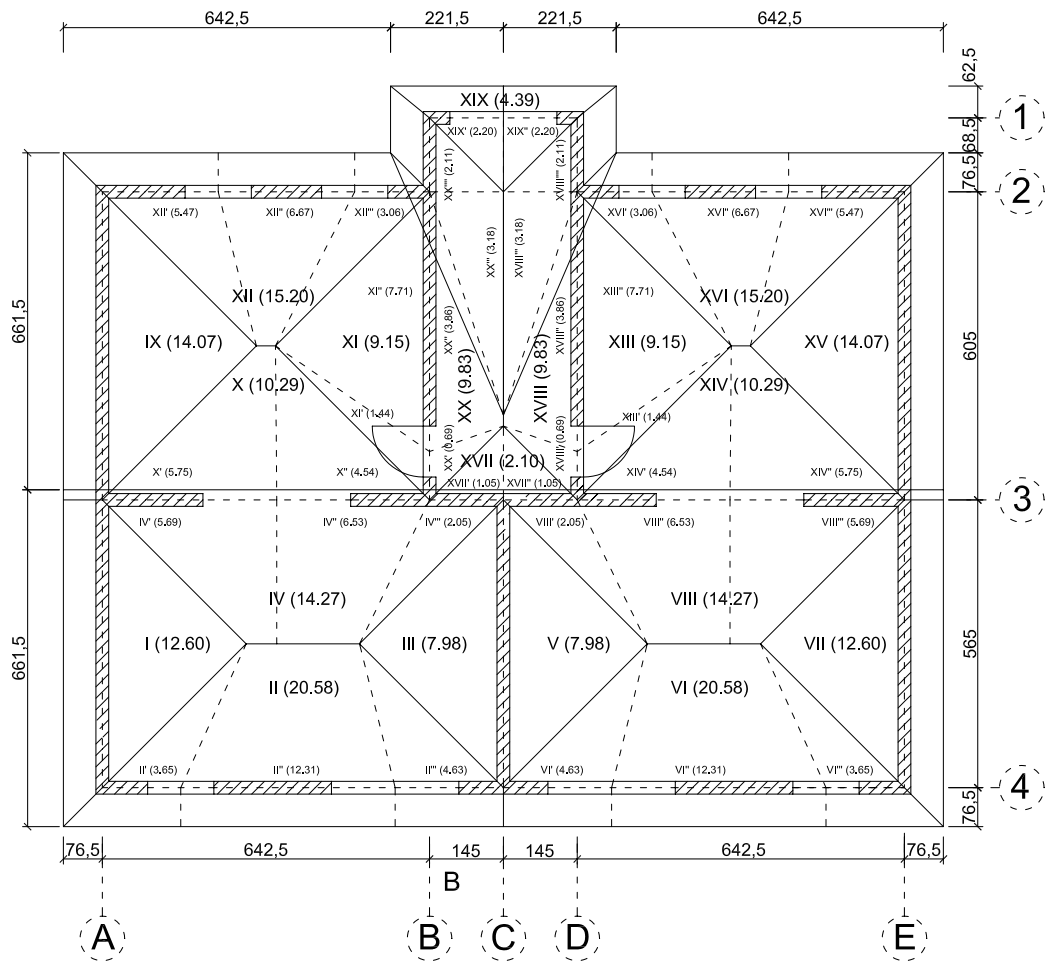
Darstellung der Dachlasteinzugsflächen
